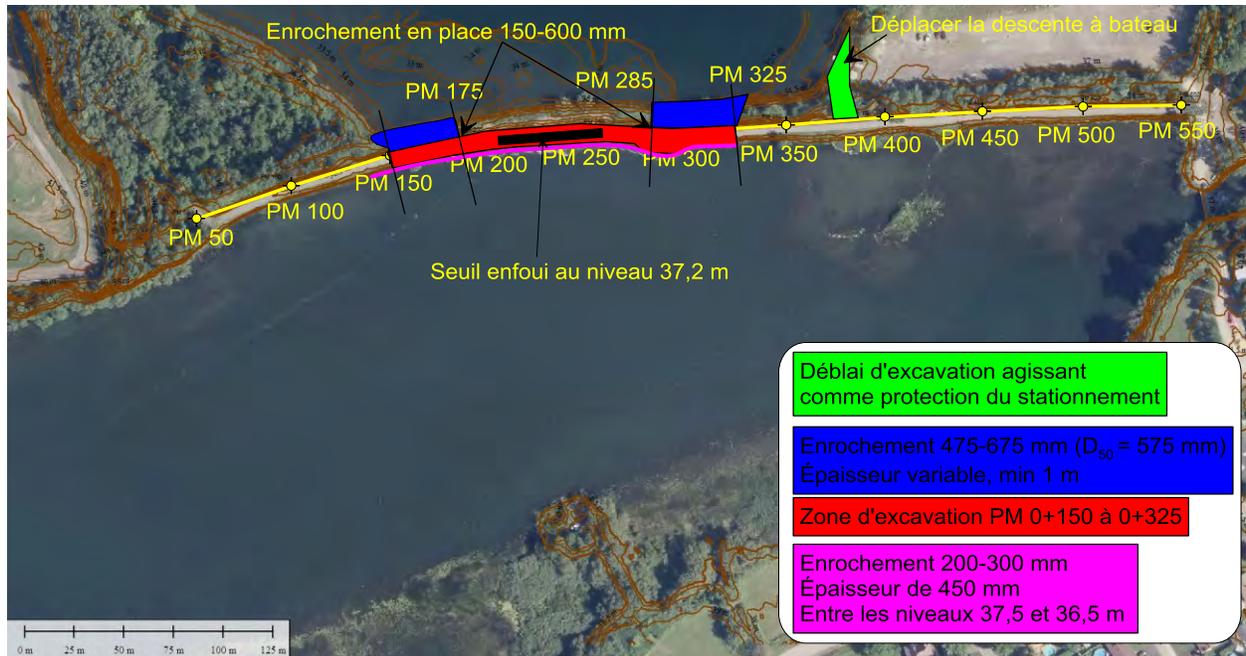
Proposition de travaux temporaires sur la Structure 1 – Vue en plan
